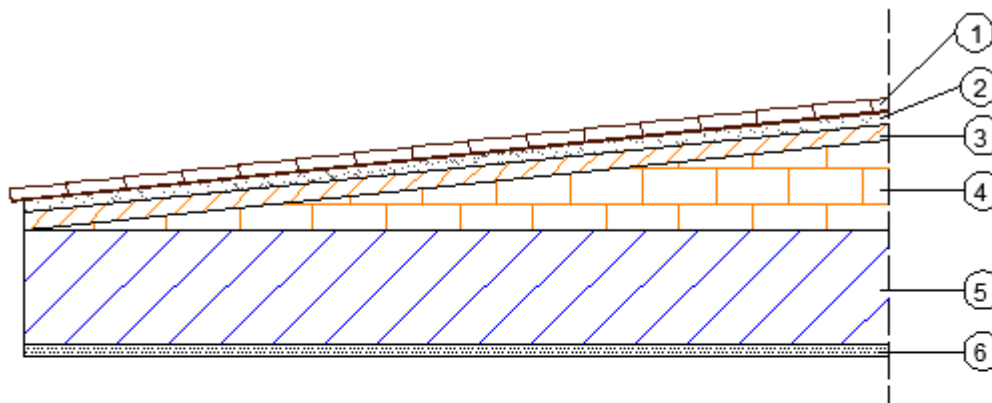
Detalle cubierta plana [Anexo II. Planos]
